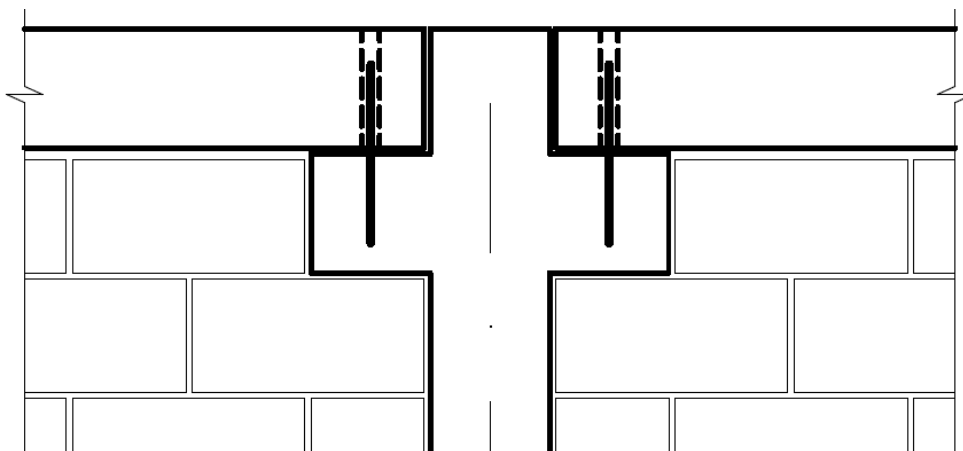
Fixação das vigas sobre os consoles dos pilares.
